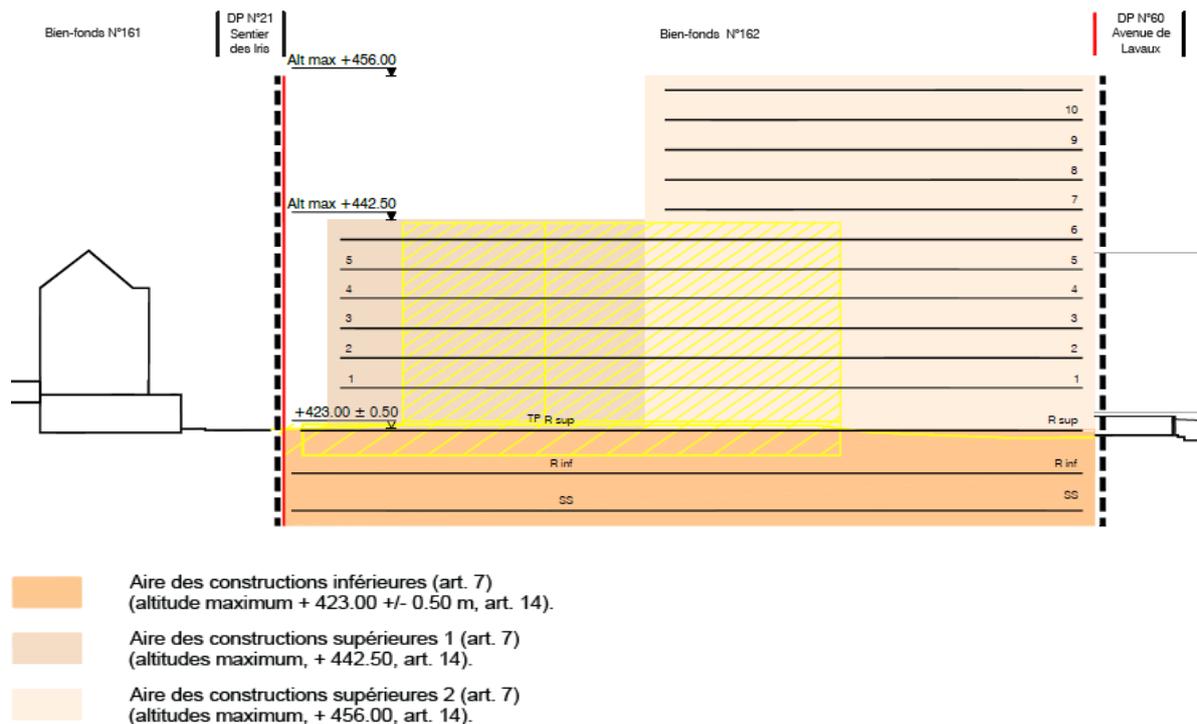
coupe du plan de détail du PA "Claire-Fontaine II" - @Ville de Pully
